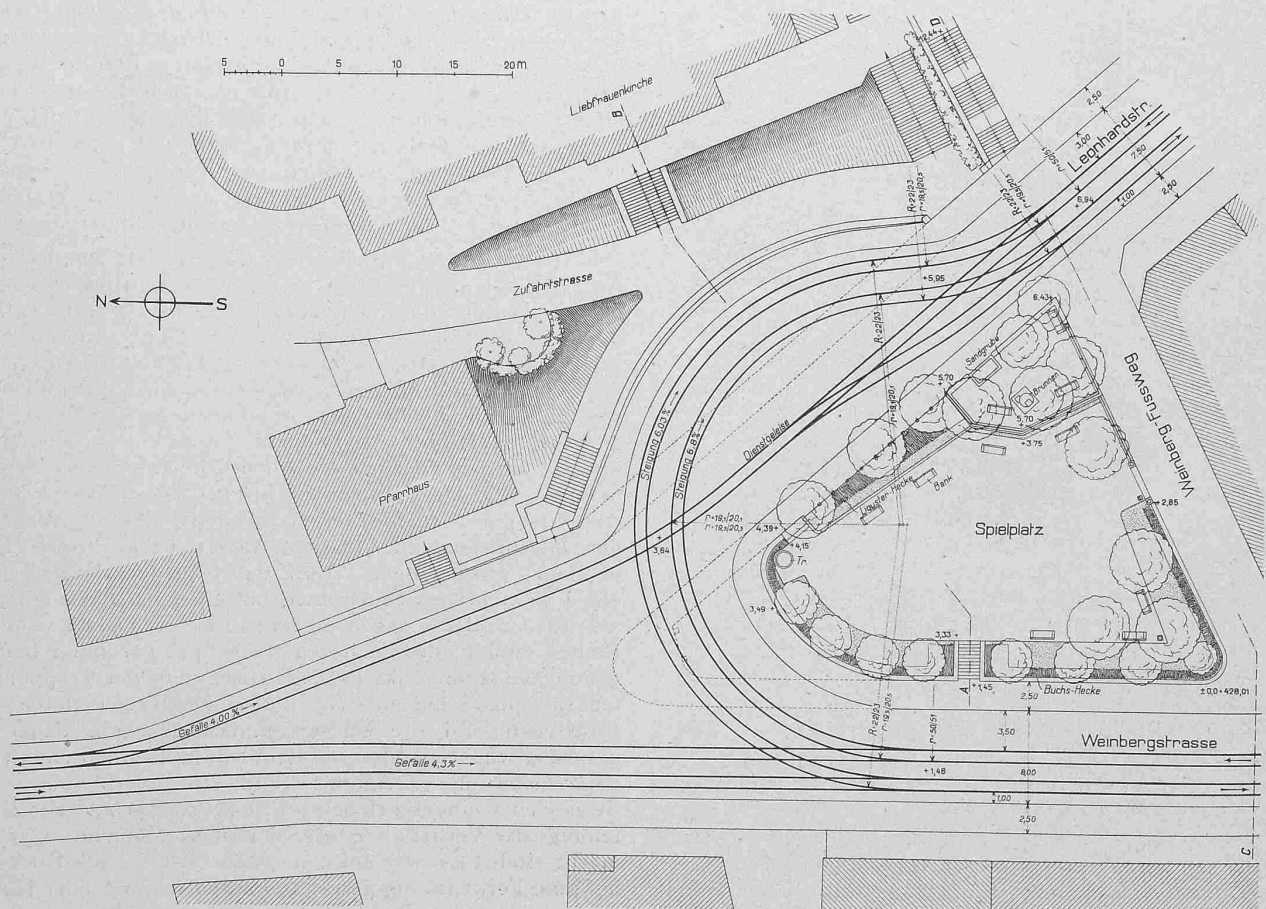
Strassenbahn-Schleife Weinbergstrasse-Leonhardstrasse in Zürich, mit Platzgestaltung des Zwickels. — Lageplan 1:600.
